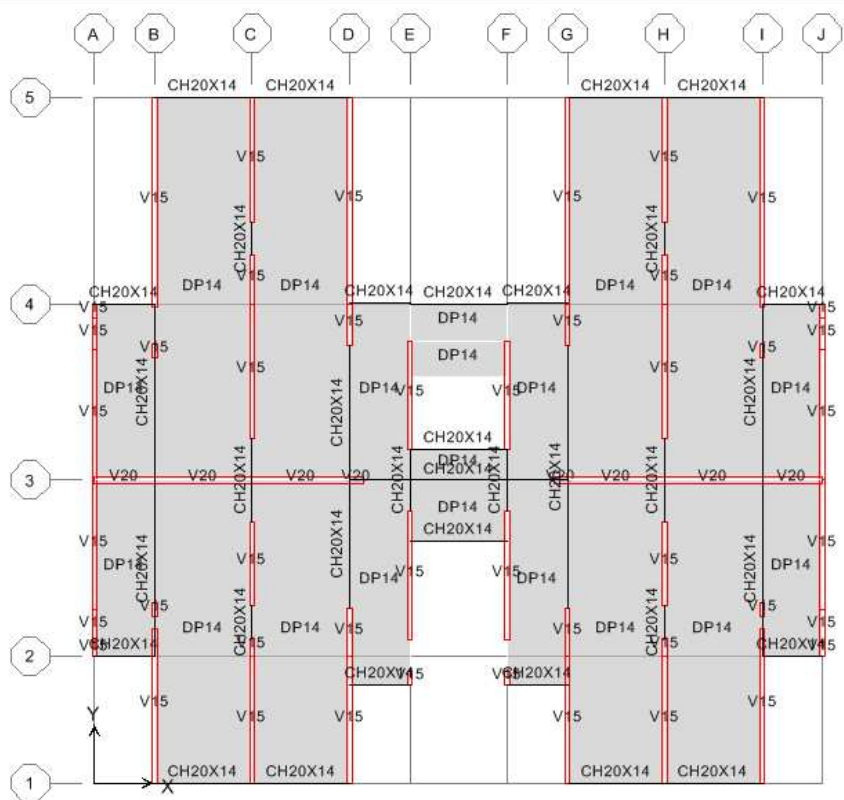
image vue en plan de la structure (coffrage tunnel) sur ETABS
